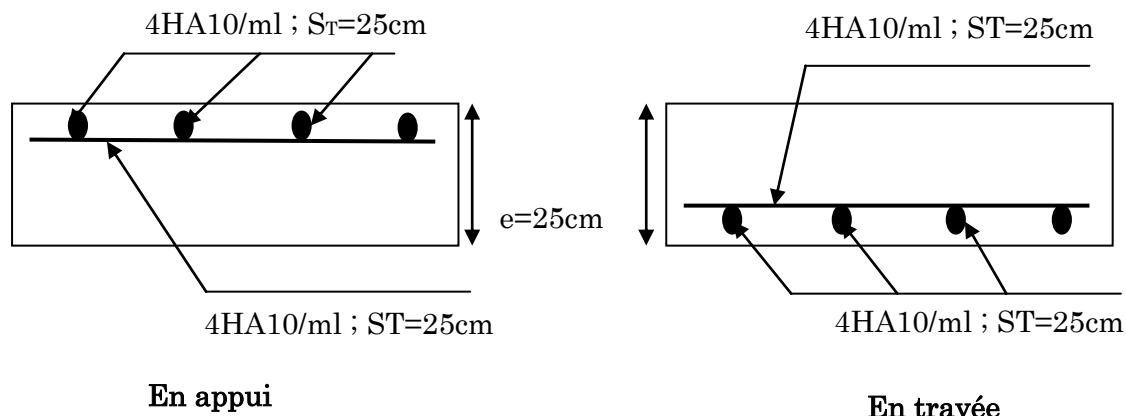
Schéma de détails de ferrailage –dalle du local machine-dalle de la cuvette
